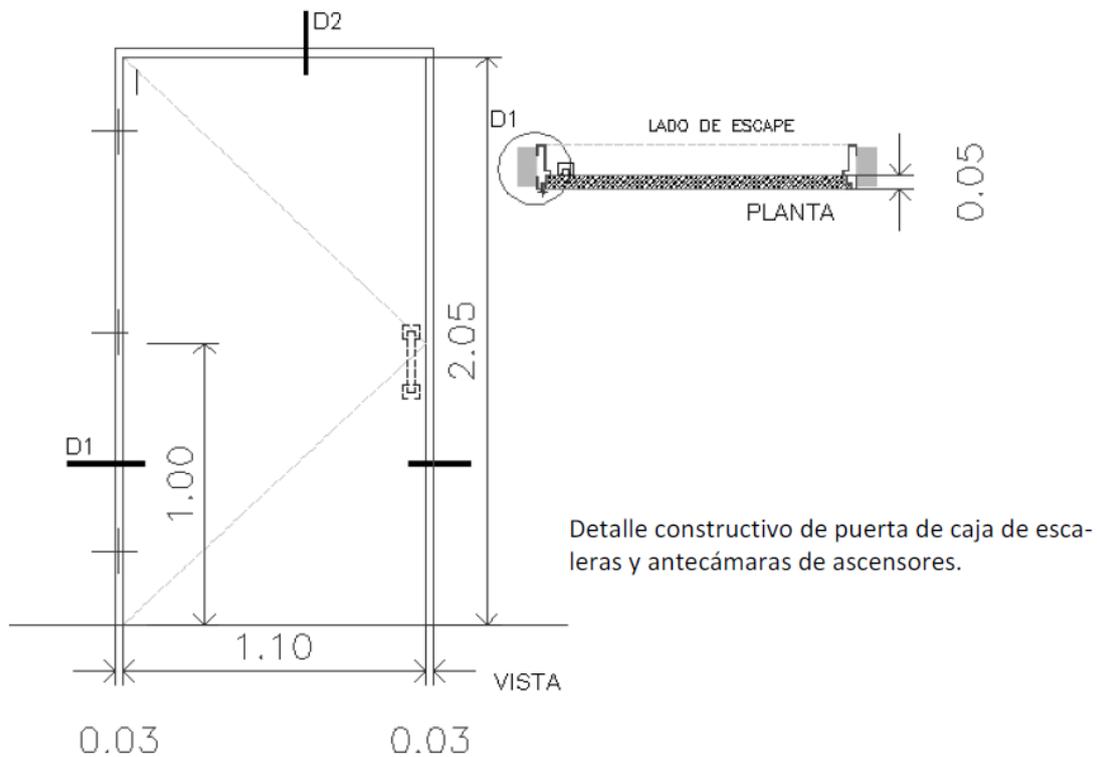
Detalle constructivo de puerta de caja de escaleras y antecámaras de ascensores.
